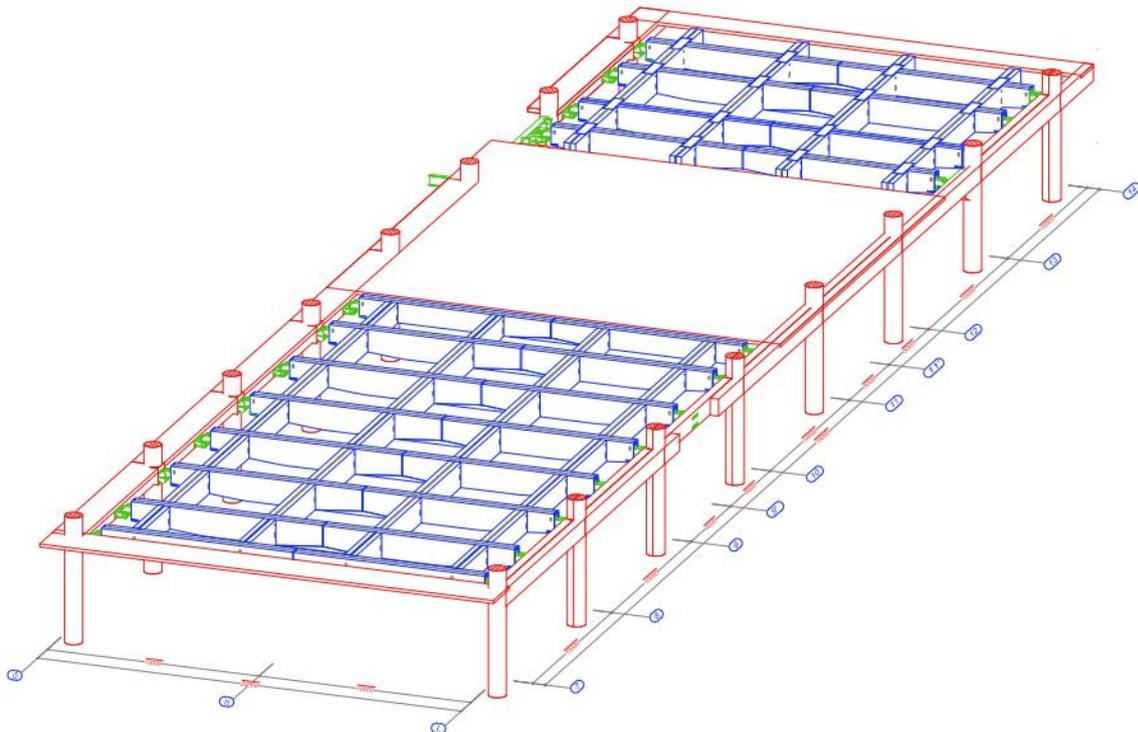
Grundriss der Krankenhausdächer in Dubai
